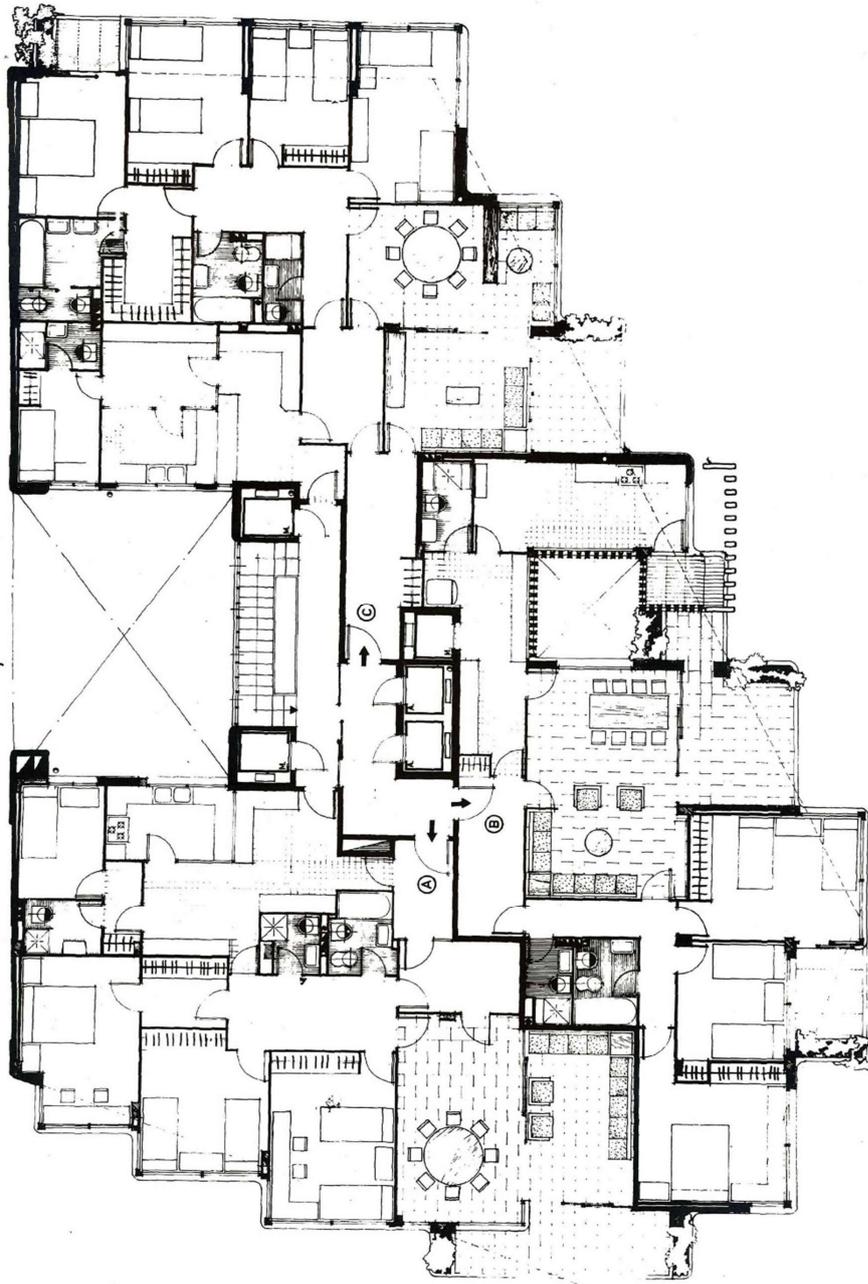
Plano original de la planta del edificio Hispania en Murcia.
